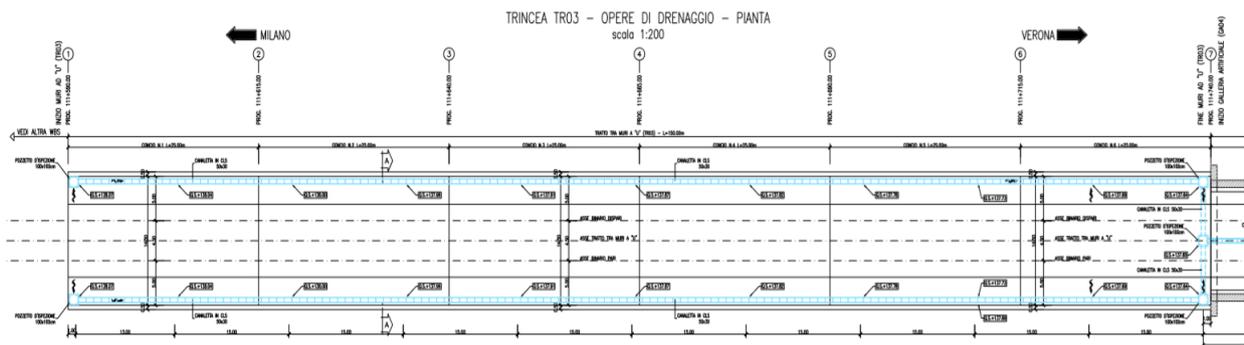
Trincea TR03 – Opere di drenaggio - Pianta
